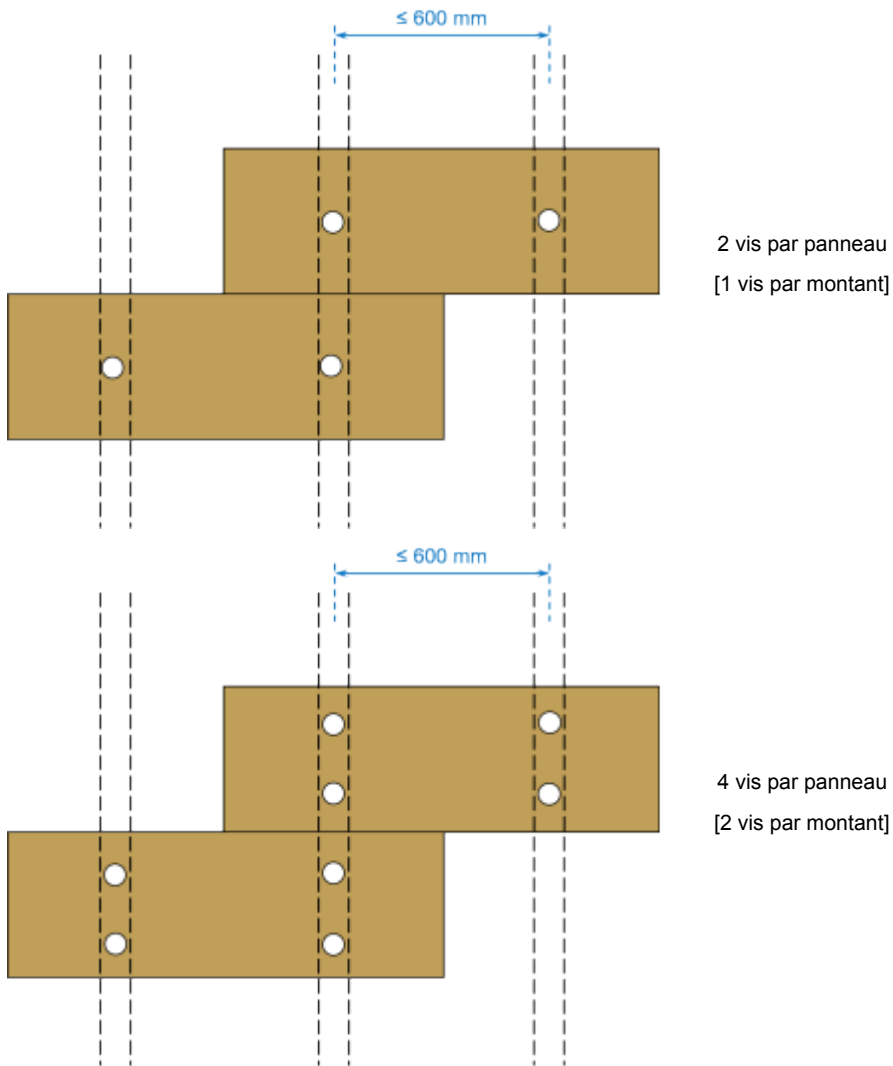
Fixation par vis à rosace – exemples de plans de fixation des panneaux isolants STEICOPROTECT L DRY de dimensions 1200 x 400 mm, en partie courante
